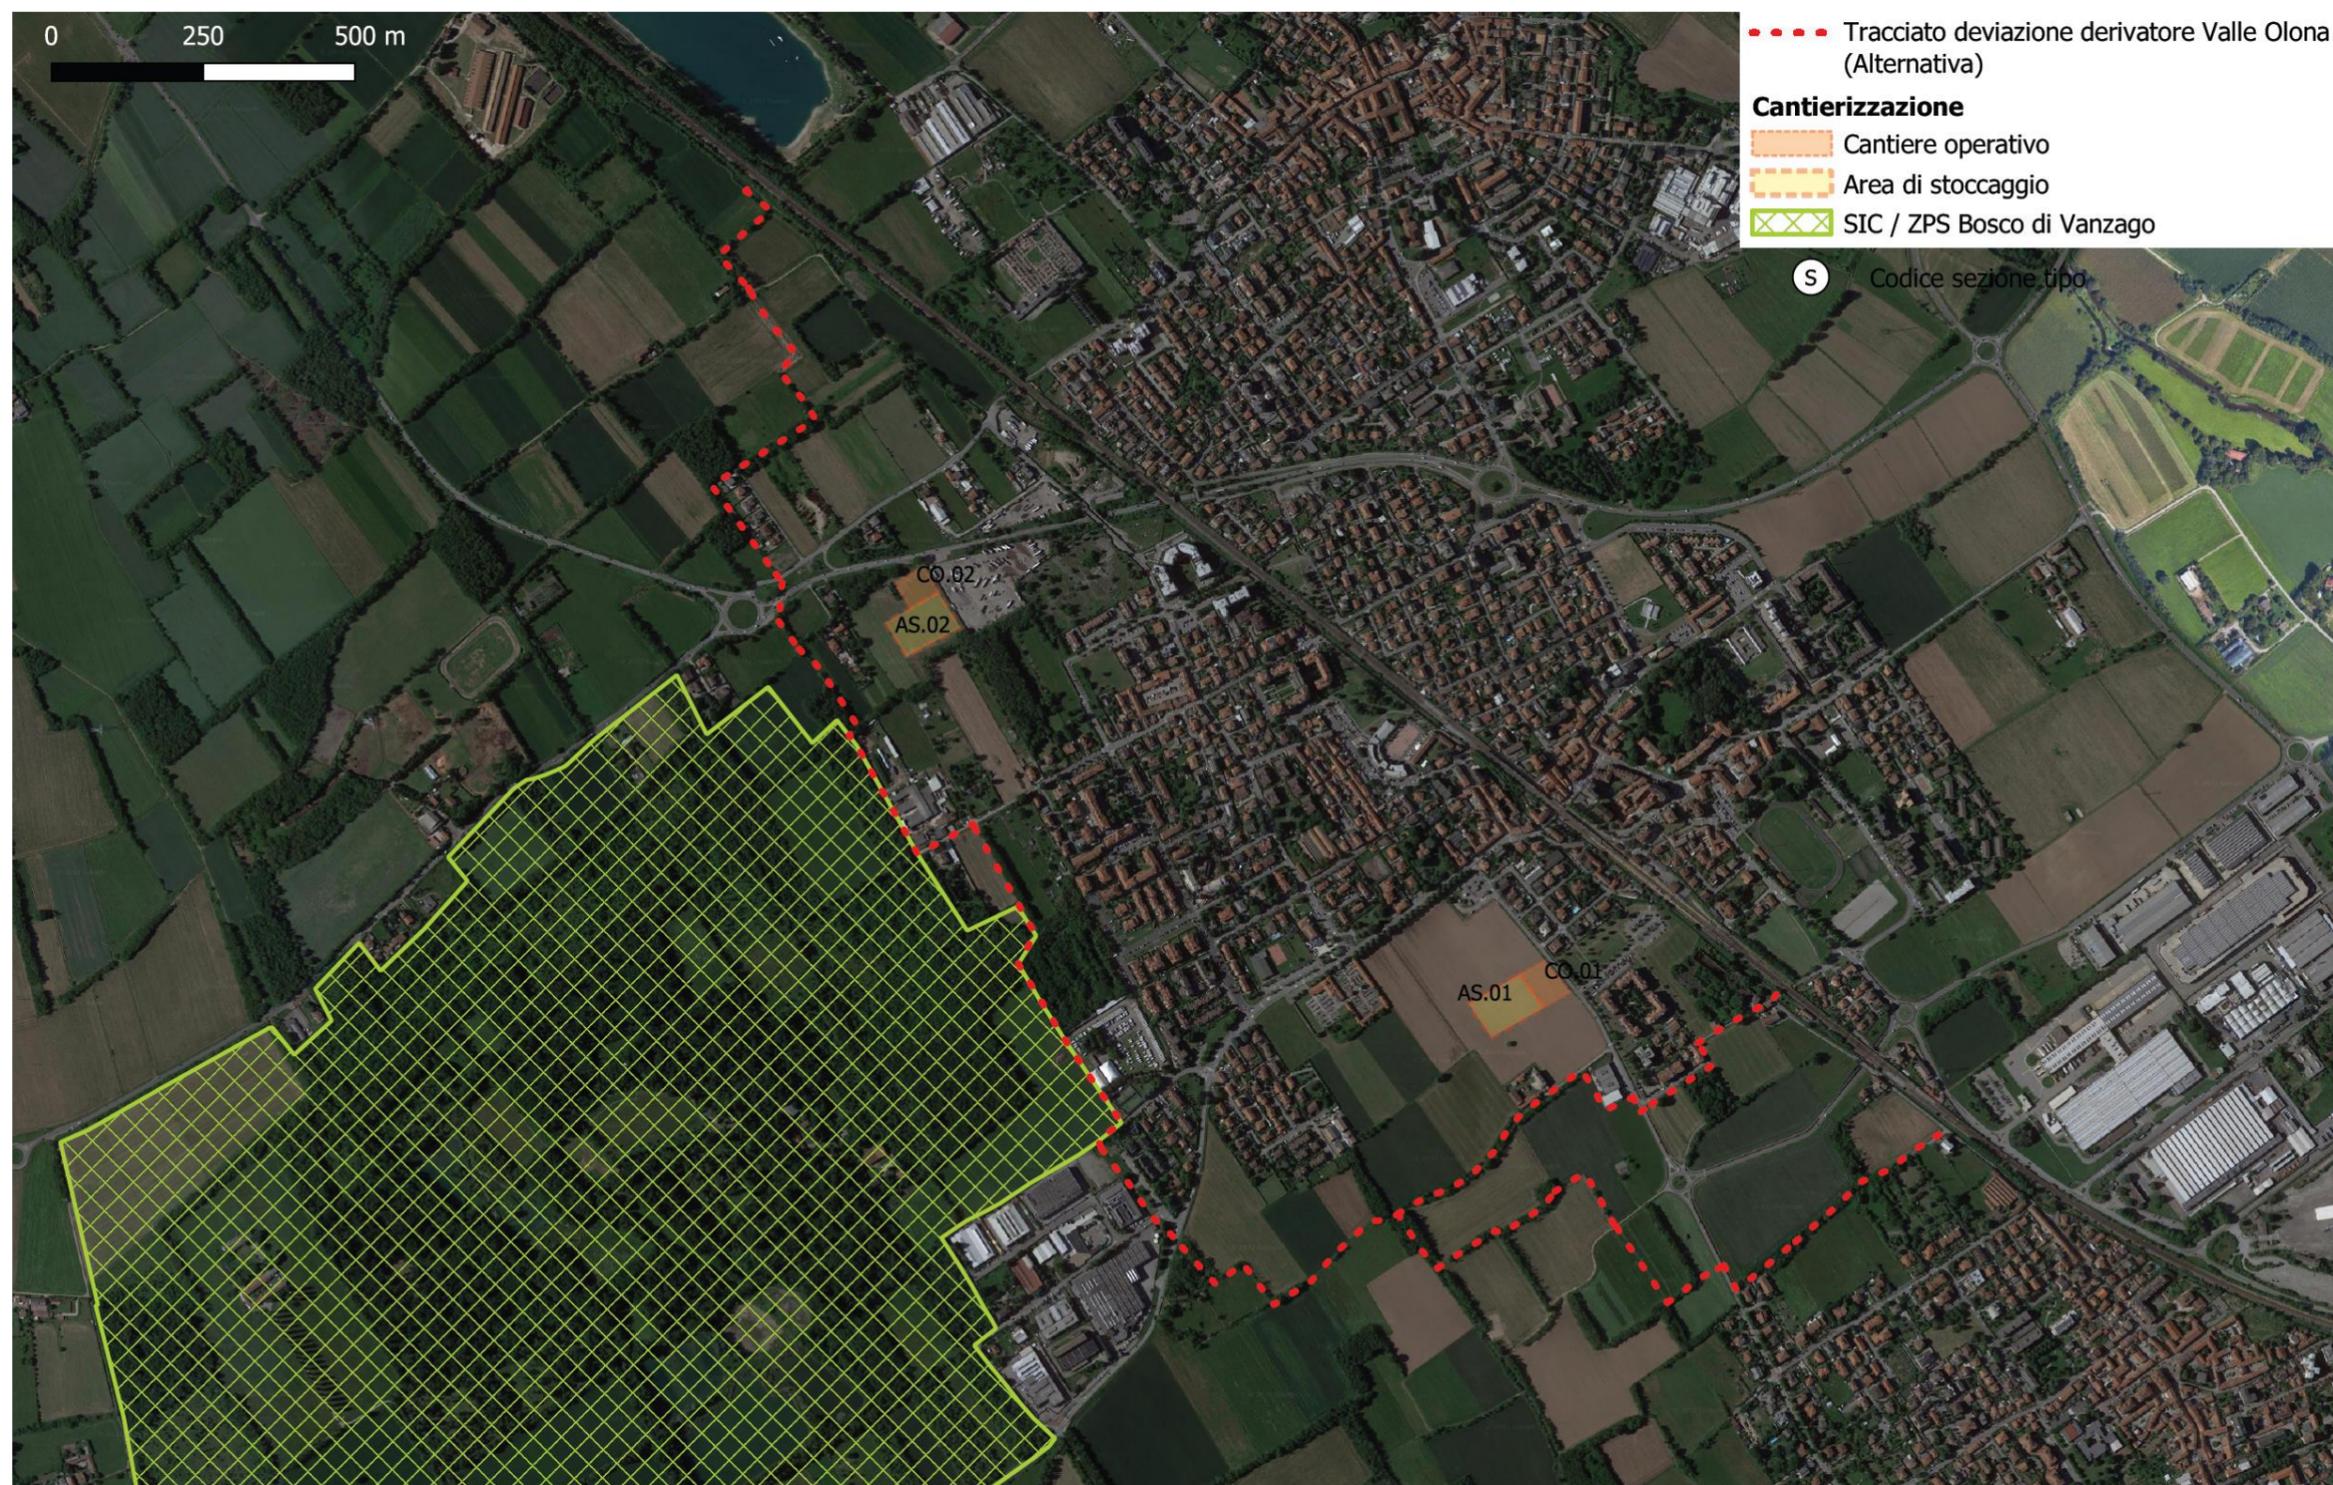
Sistema di cantierizzazione – Inquadramento su foto aerea
